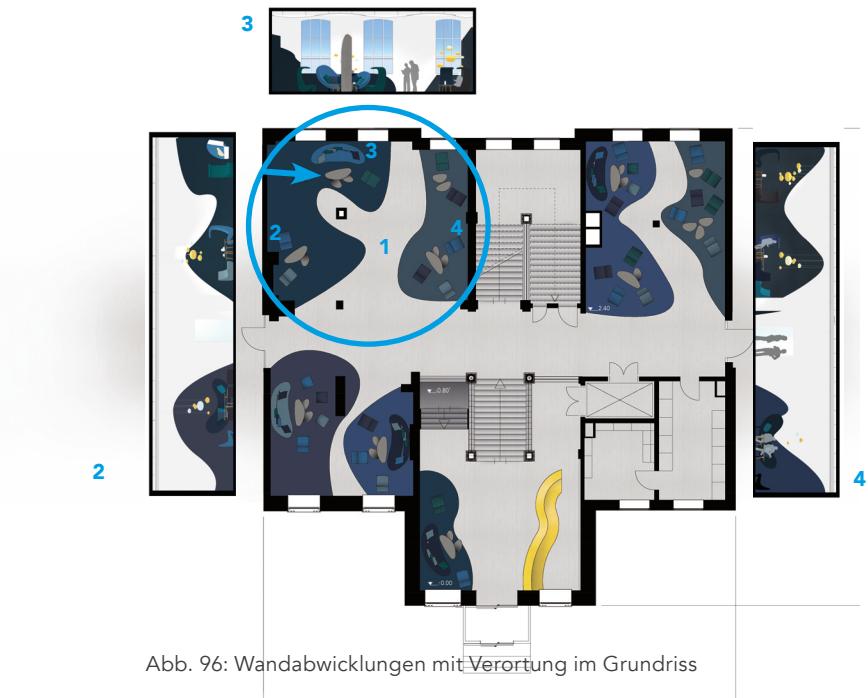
Wandabwicklungen mit Verortung im Grundriss
